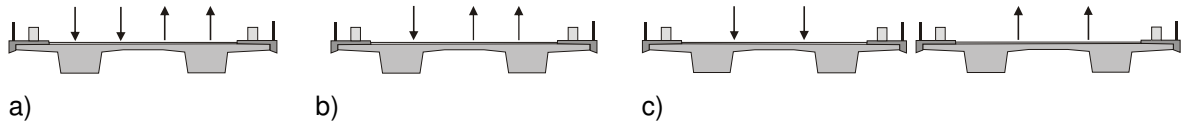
Brücken mit Straßenquerschnitten von zwei oder mehr Fahrstreifen in einer Fahrtrichtung
